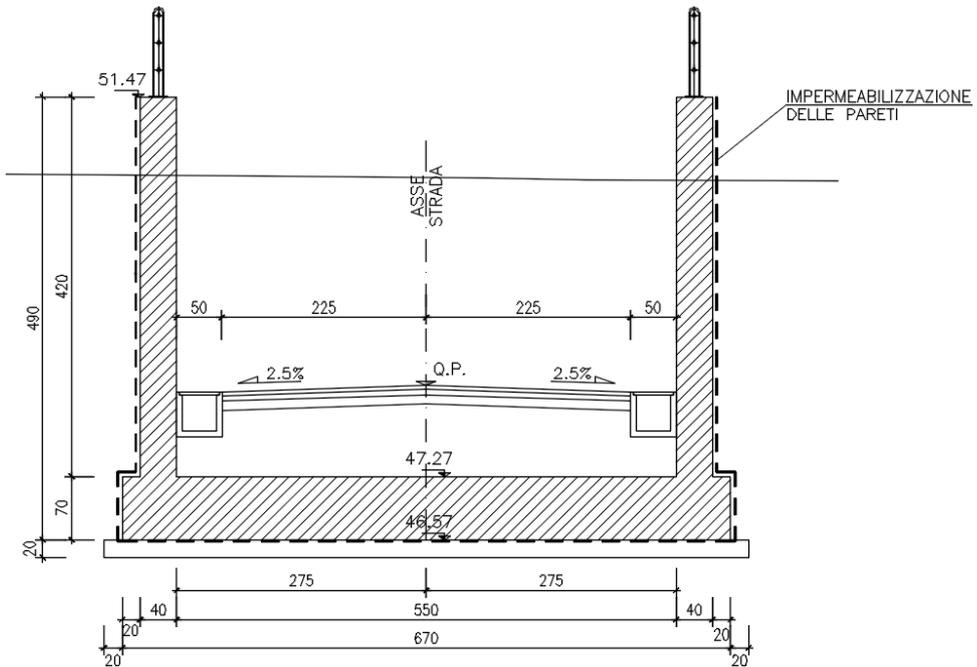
Sezione 2 di calcolo muri di imbocco SL13
